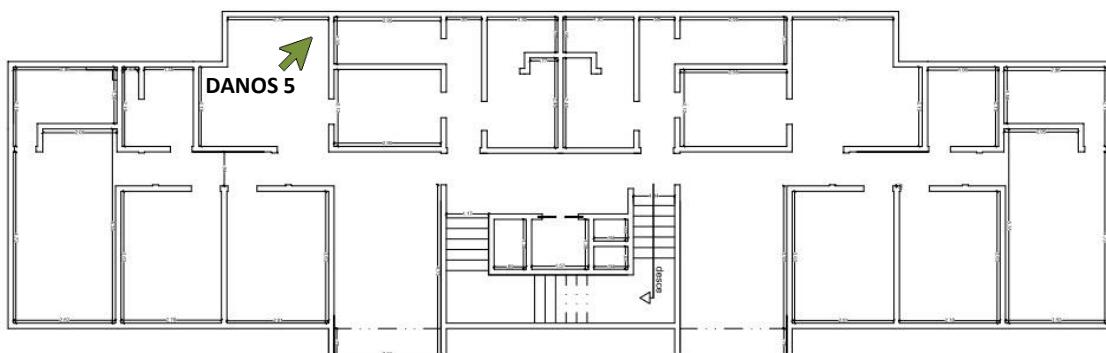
Planta Baixa (croqui) do Pavimento do 1º andar – Bloco C – Cond. Armando Lôbo.
